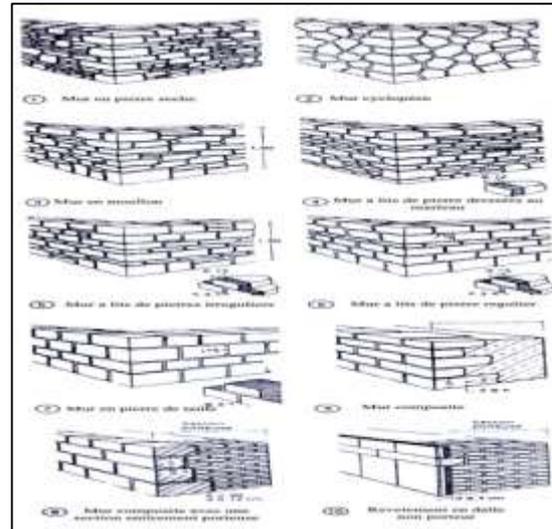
différentes type de murs en pierre : (sources: alliche:2018)
